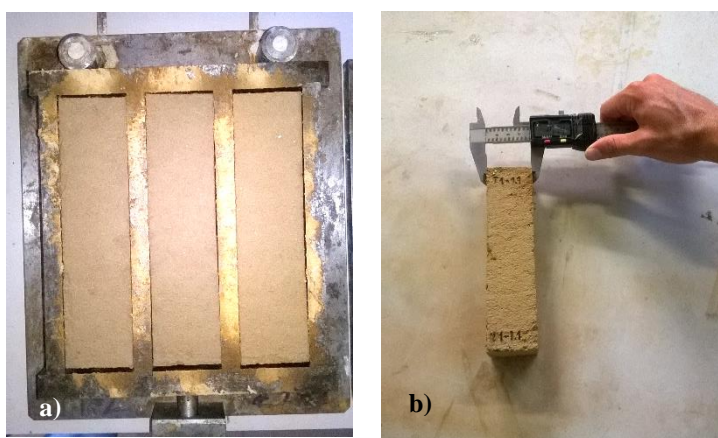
a) Retração no molde; b) Medição das dimensões do provete
